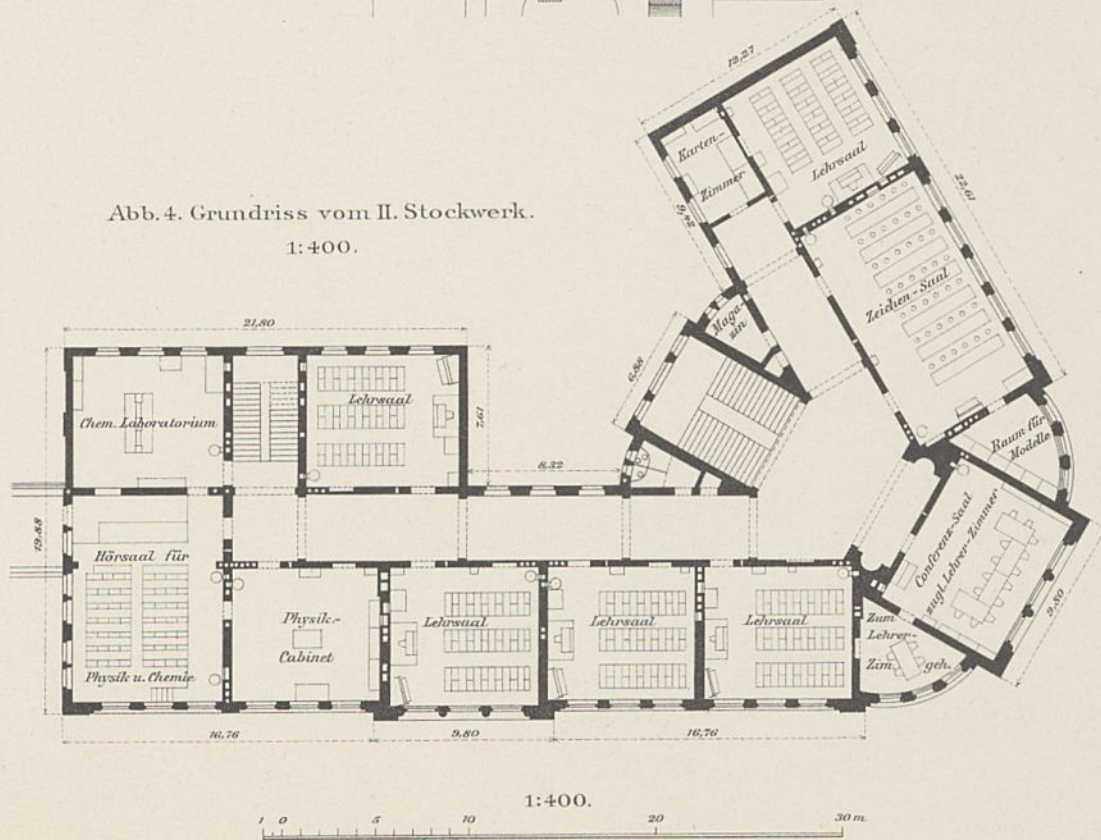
Grundriss vom II. Stockwerk.
